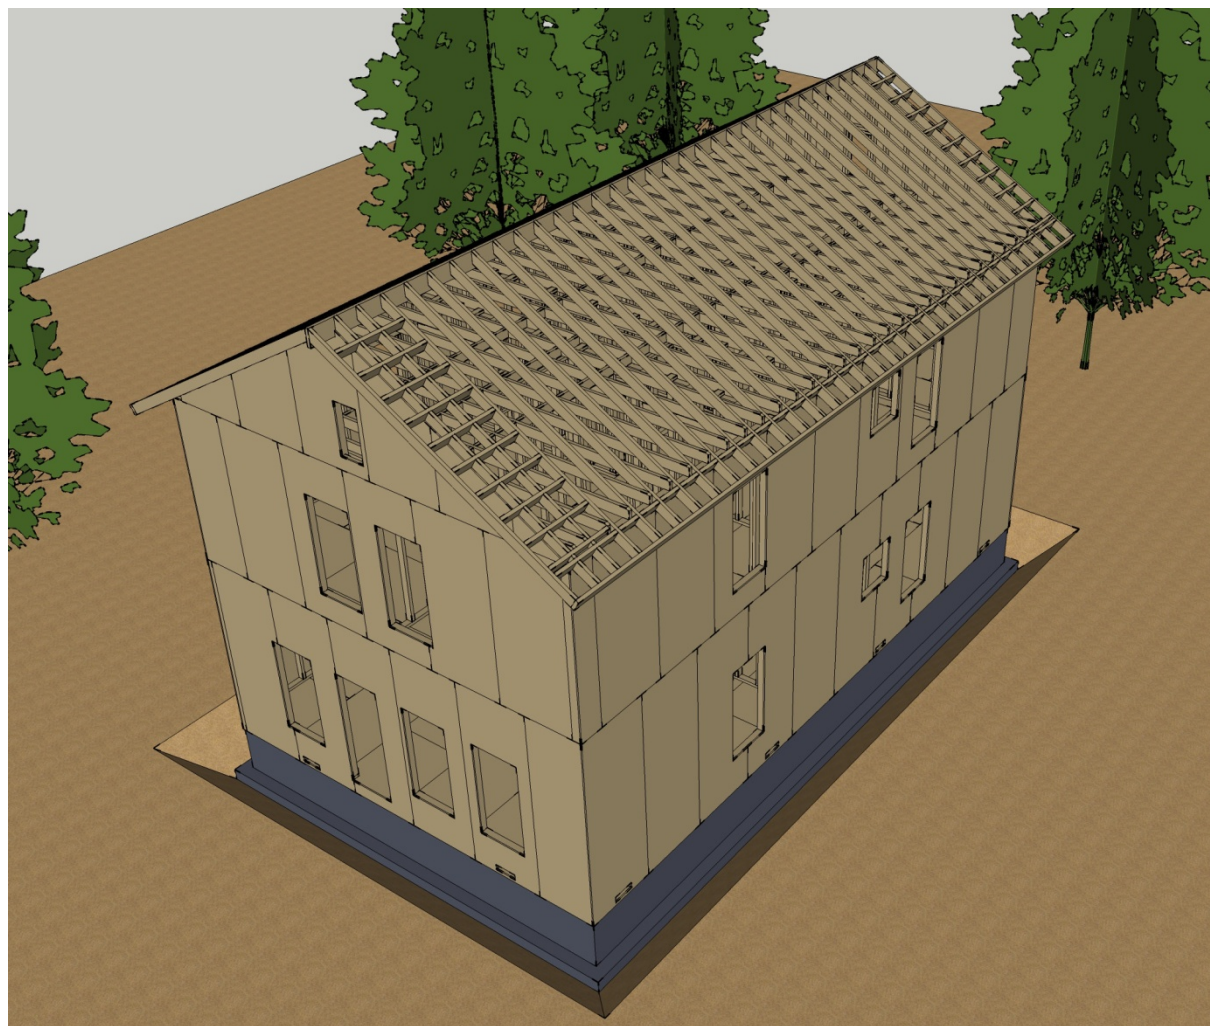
Montagem do forro estrutural das paredes de fecho da empena.
